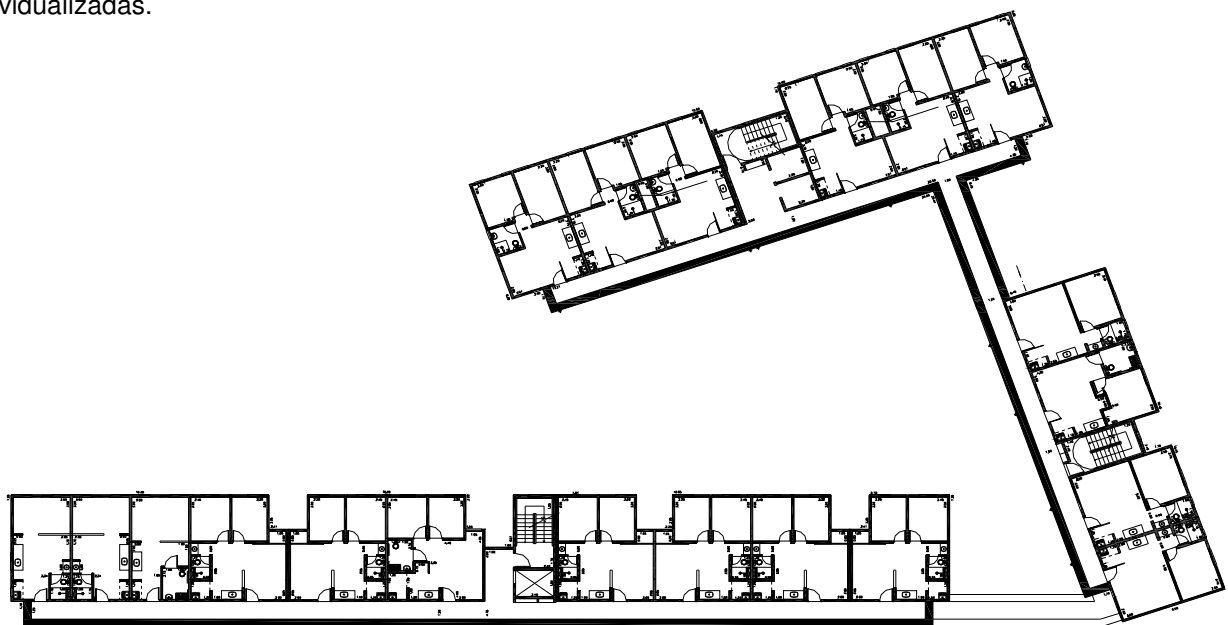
Planta Pavimento Tipo – C. H. Residencial Olarias
